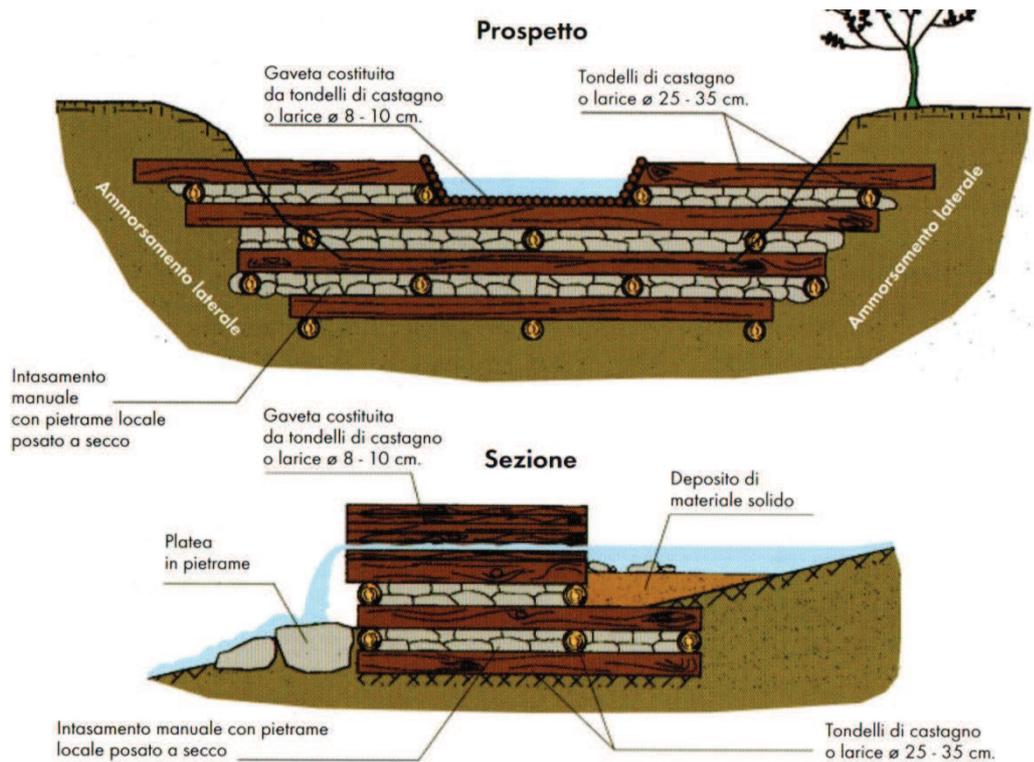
Schema di briglia in legname e pietrame (Consorzio Valle Allione 2009).
